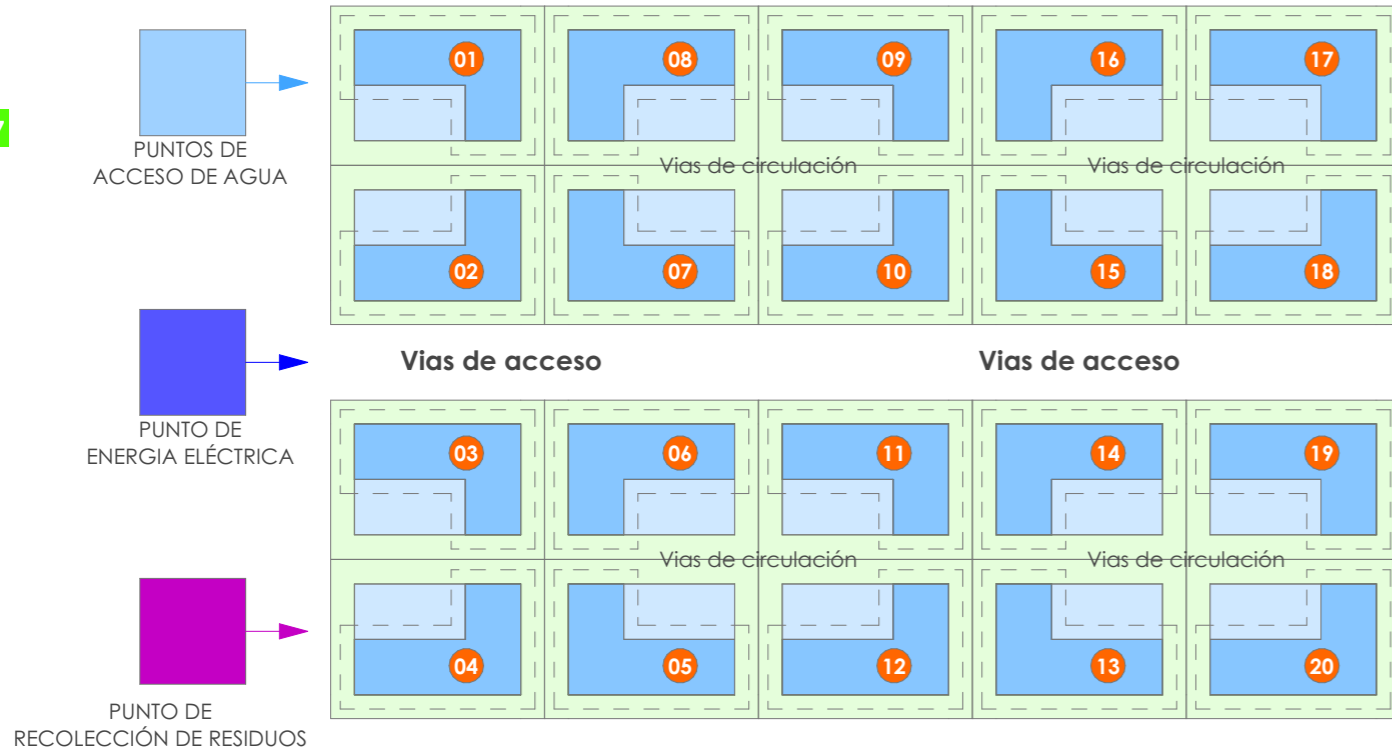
Conjunto de viviendas emergentes zona urbana. Elaboración Propia.
